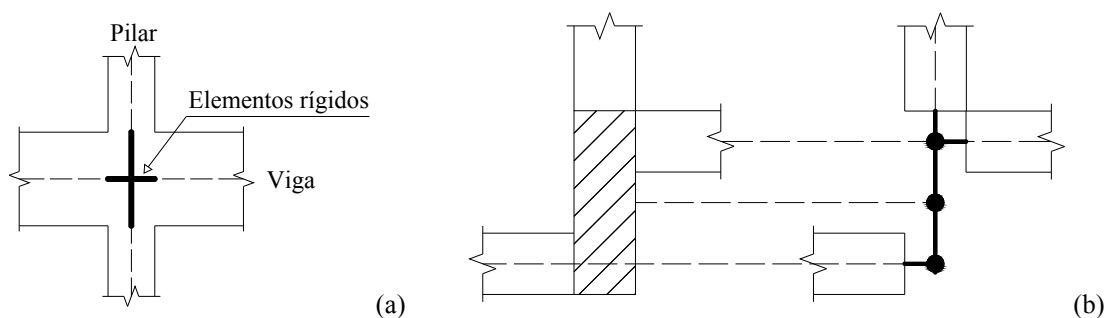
Elementos rígidos: (a) na zona do nó viga-pilar; (b) modelação do pilar rectangular.
